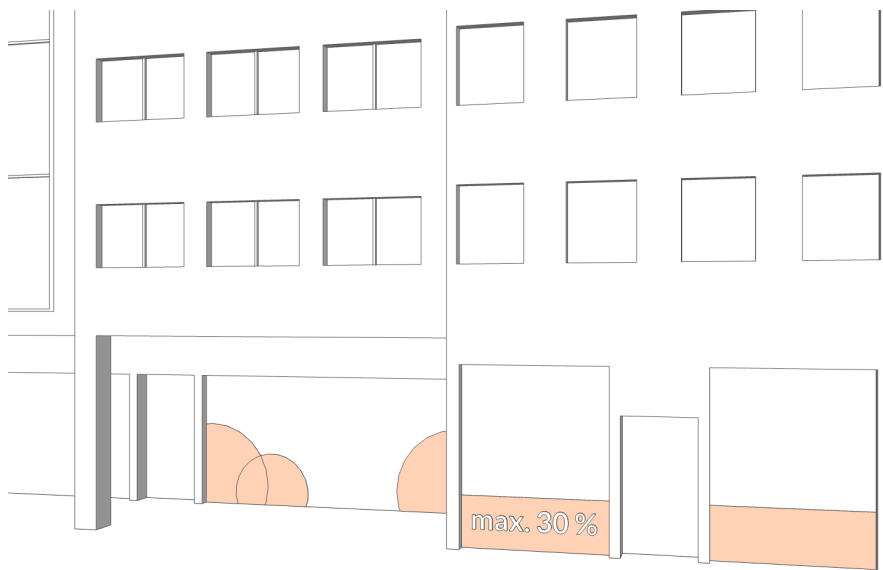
Skizze zu verschiedenen Werbebeklebungen an einer Fassade
